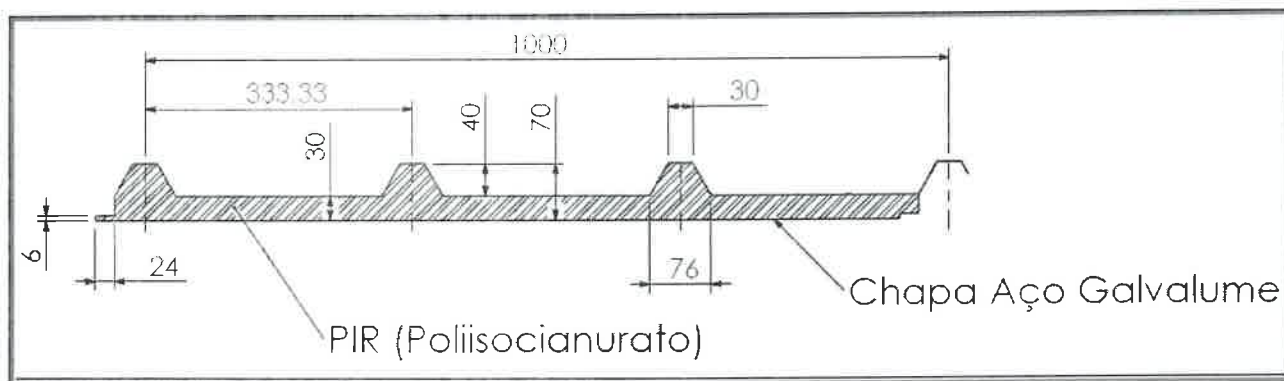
Seção transversal do painel de telhado (Dimensões em mm).
